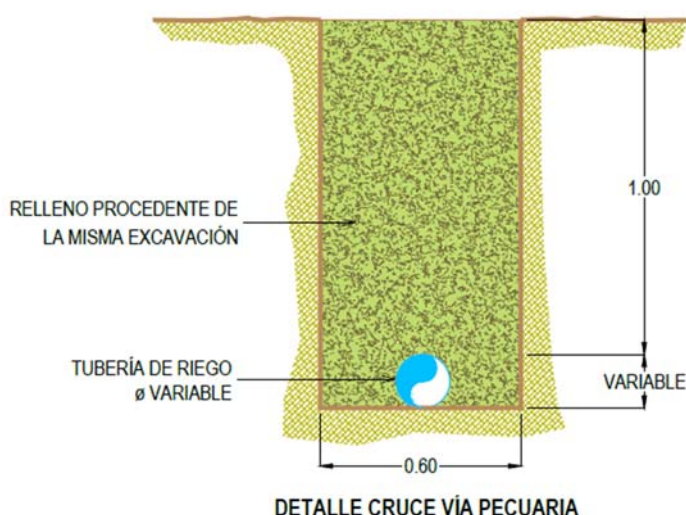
Detalle de zanja para instalación de la tubería de riego.
